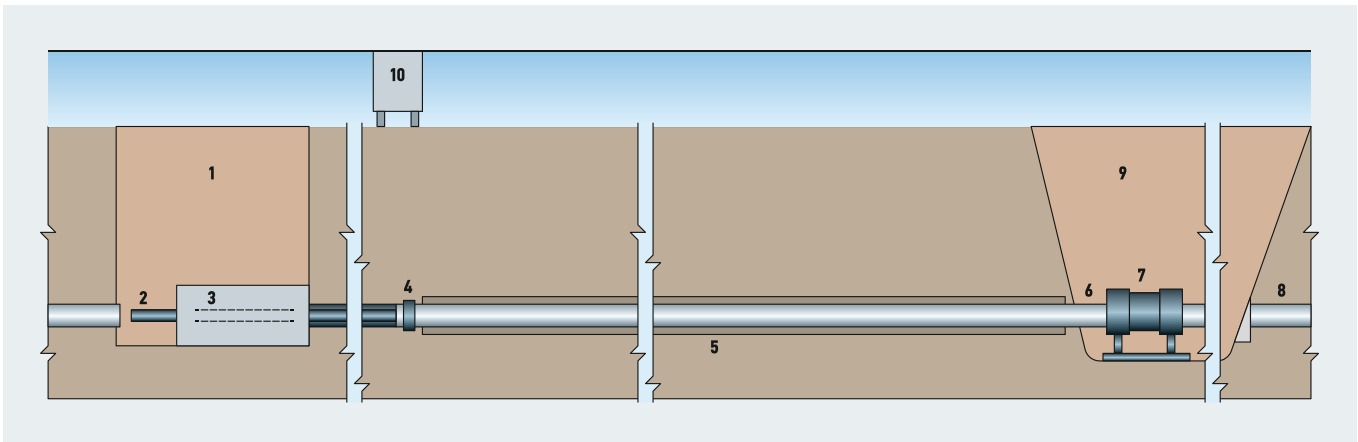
Технологическая схема бестраншейного восстановления напорного трубопровода трубами из ВЧШГ с использованием машины с наборными штангами МНШ [1 и 9 — котлованы; 2 — наборные штанги; 3 — машина с наборными штангами; 4 — разрушитель-расширитель; 5 — осколки разрушенного трубопровода; 6 — новый трубопровод из ВЧШГ; 7 — узел сборки соединения труб из ВЧШГ (рис. 3); 8 — восстанавливаемый трубопровод; 10 — пульт управления МНШ]
